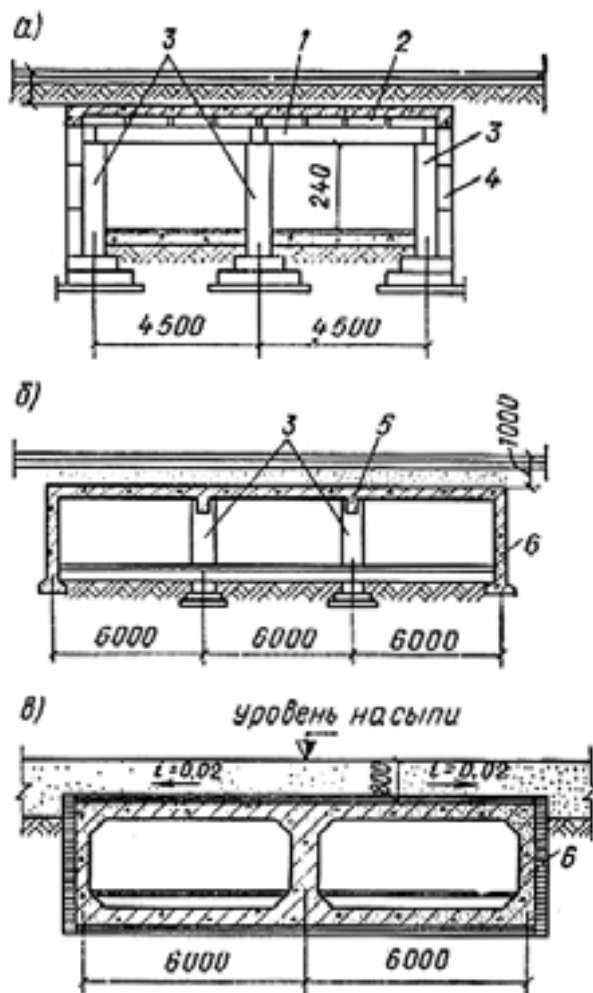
Конструктивные схемы убежищ: а – каркасно-панельная с полным каркасом; б – каркасно-панельная с неполным каркасом; в – бескаркасная; 1 – сборный железобетонный ригель; 2 – сборно-монолитное перекрытие; 3 – железобетонные колонны; 4 – стеновые панели; 5 – монолитная железобетонная плита перекрытия; 6 – монолитные железобетонные стены
